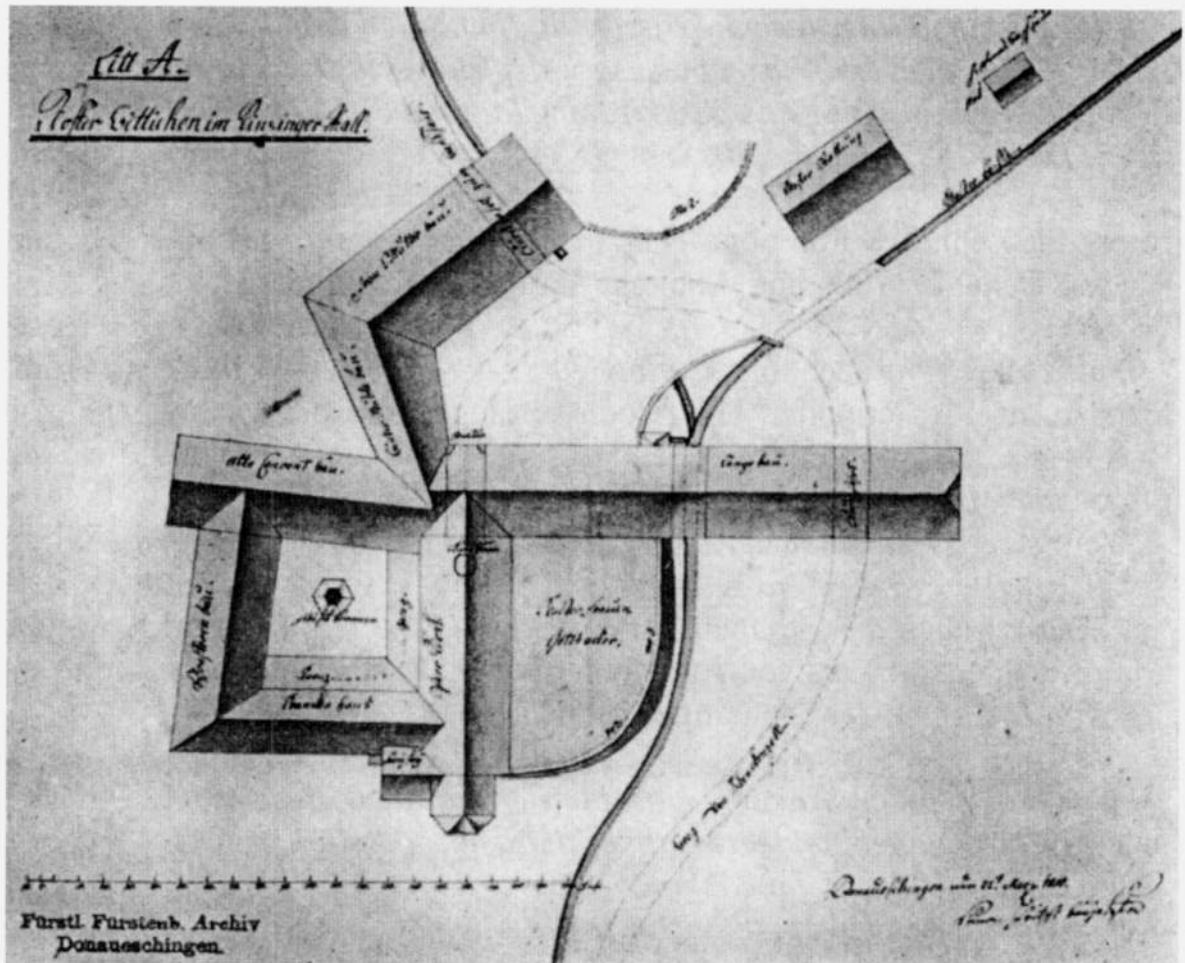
Lageplan (Grundriss) der Klostergebäude zu Wittichen aus dem Jahr 1810 mit Angabe der einzelnen Bauteile. Aus: Hiß, 1966, 142
